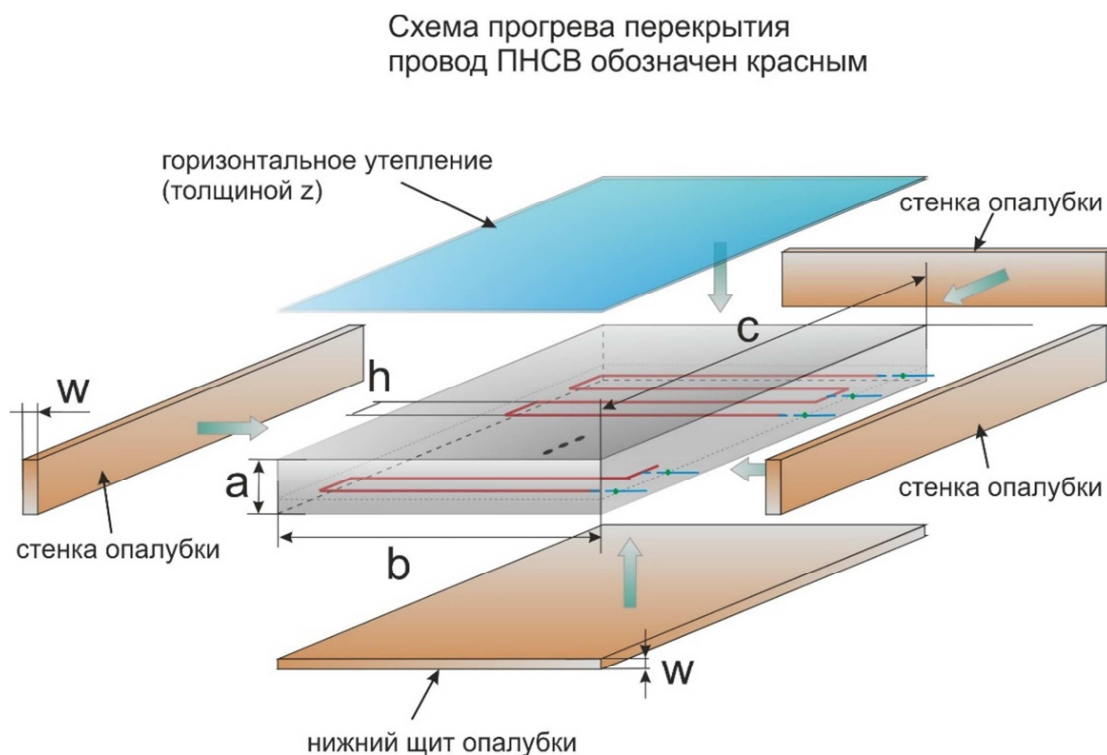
Принципиальная расчетная модель-схема бетонирования плиты перекрытия в строительный период зимой [42]
